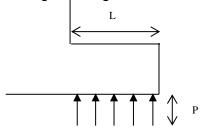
Schema di calcolo per le sollecitazioni sul plinto di fondazione
